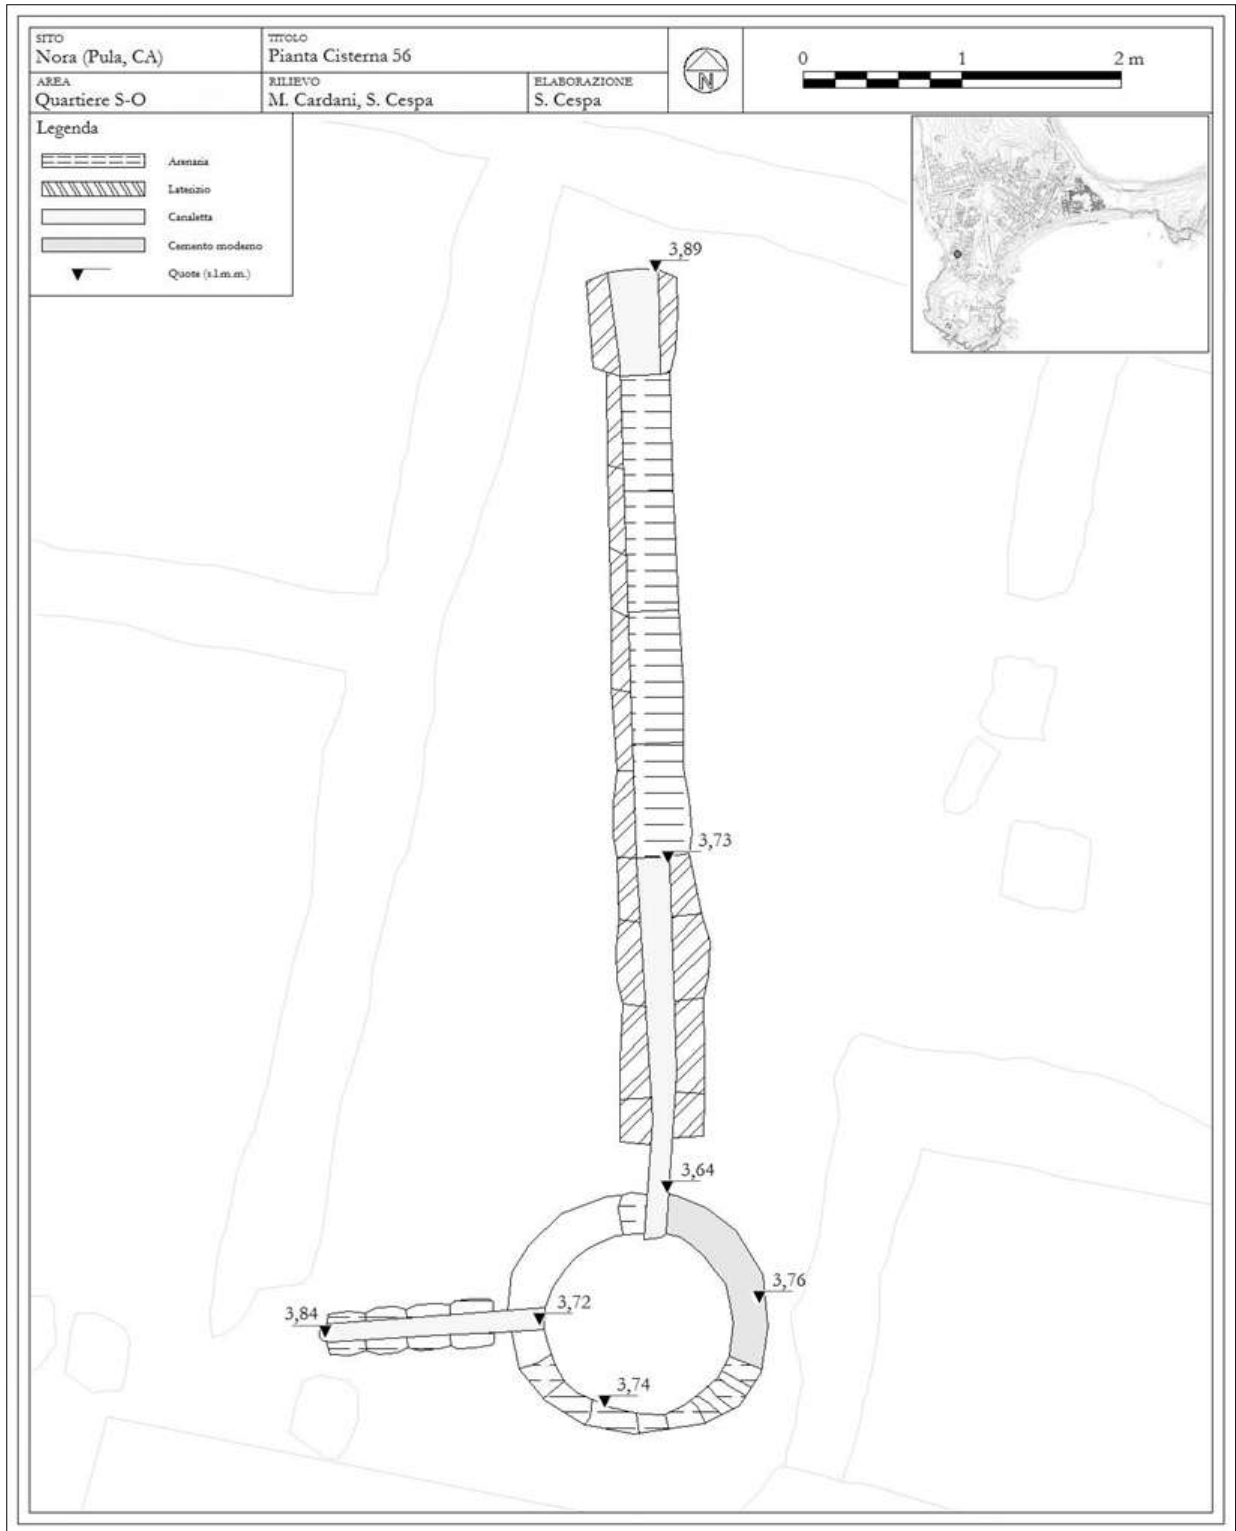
Pianta della cisterna 56 (elaborazione dell'autore).
